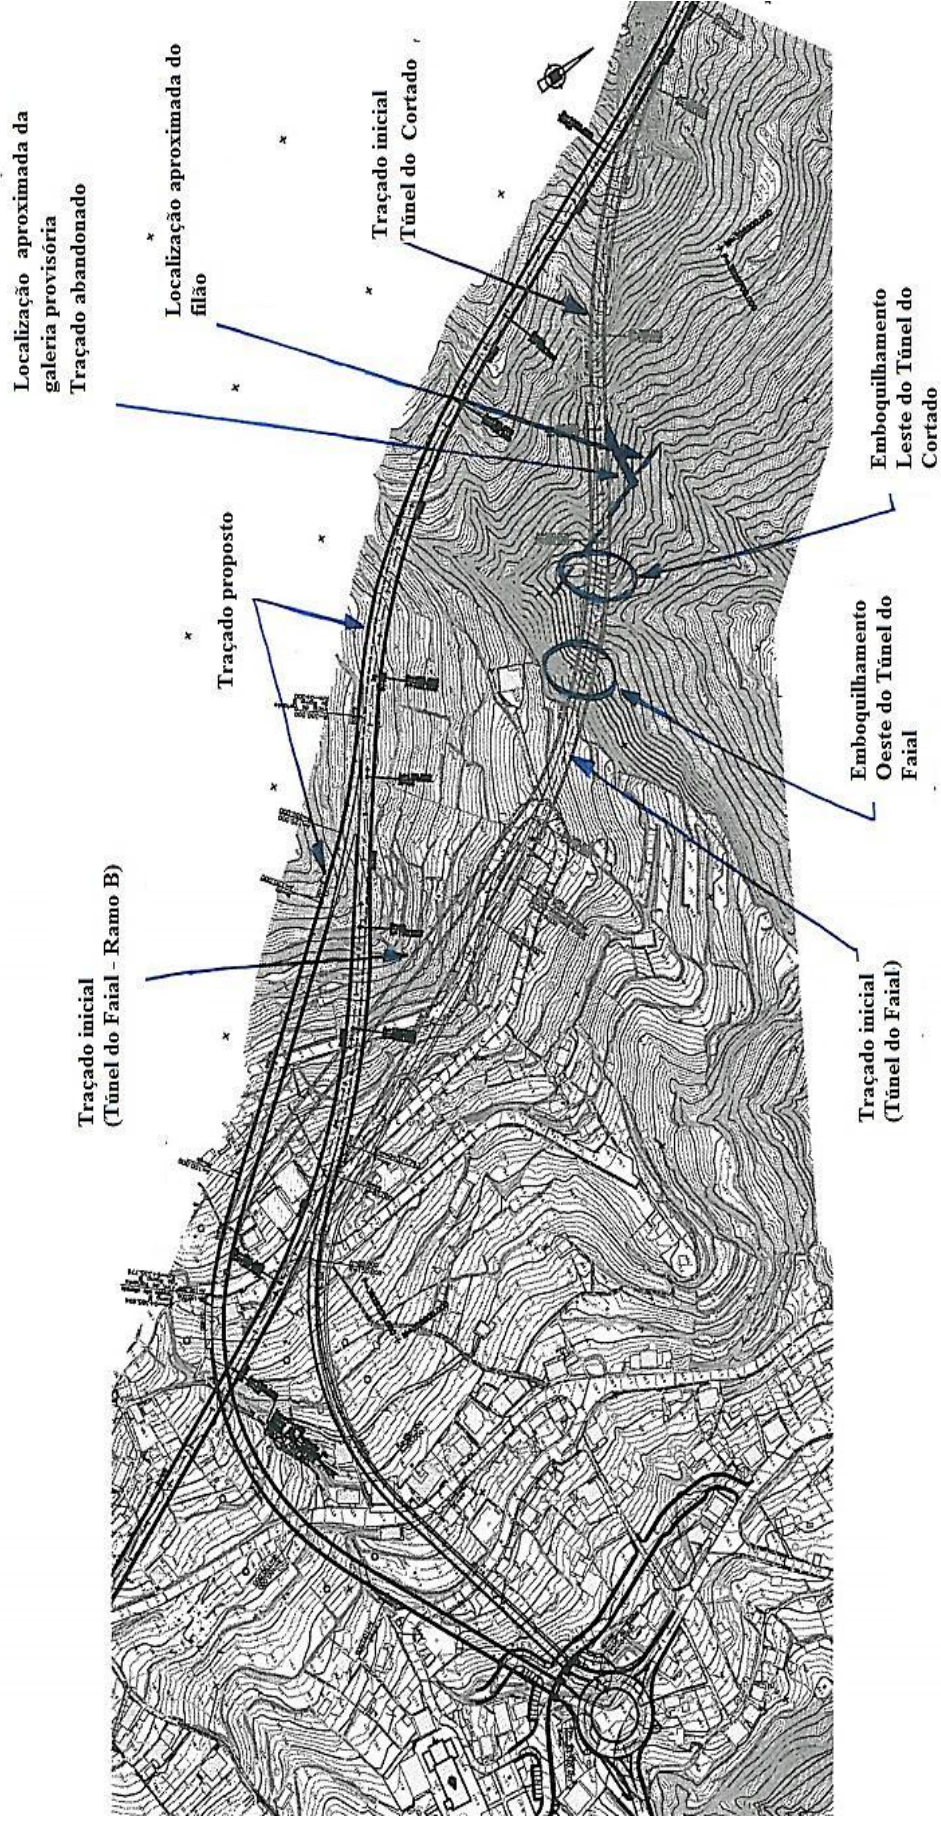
Alteração de traçado do Túnel do Cortado (GRID; CENORPLAN)
